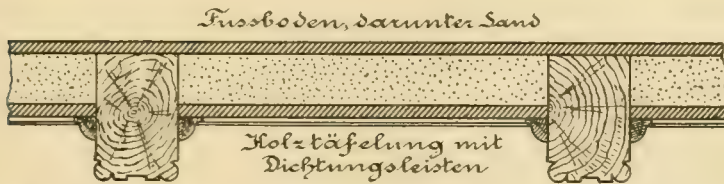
Herstellungsweise der Balkendecken in Bauernhäusern und älteren Gebäuden.
